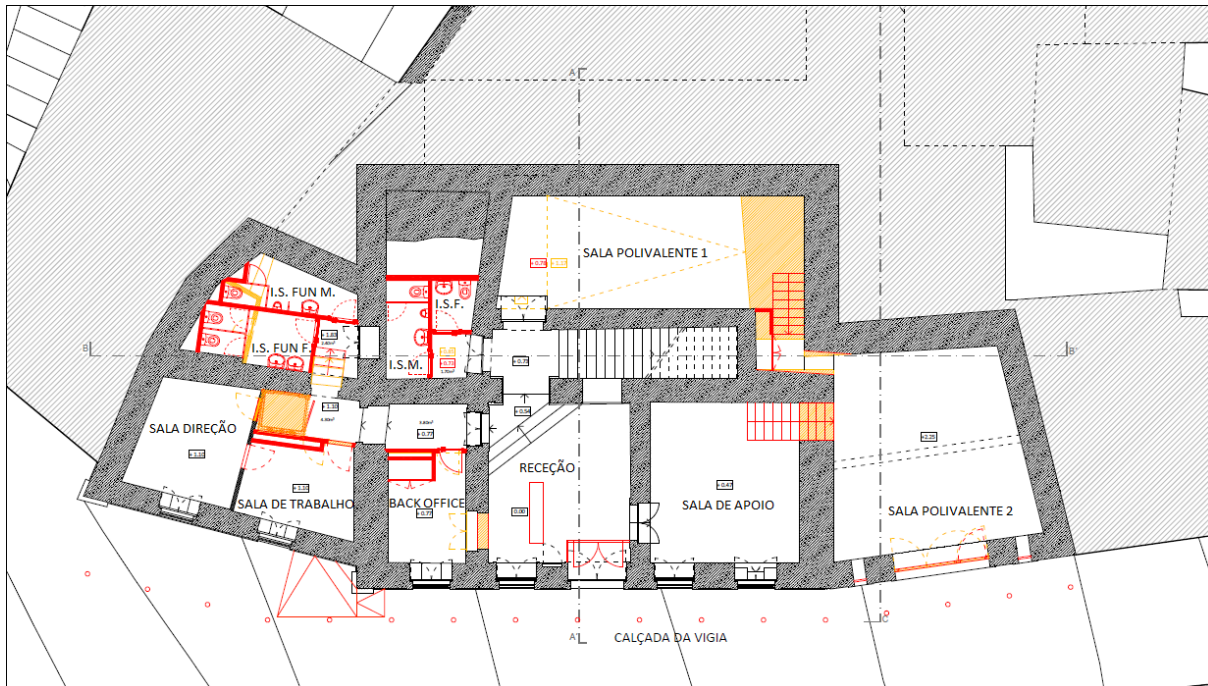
Planta do Piso 0 do edifício 1 em estudo
